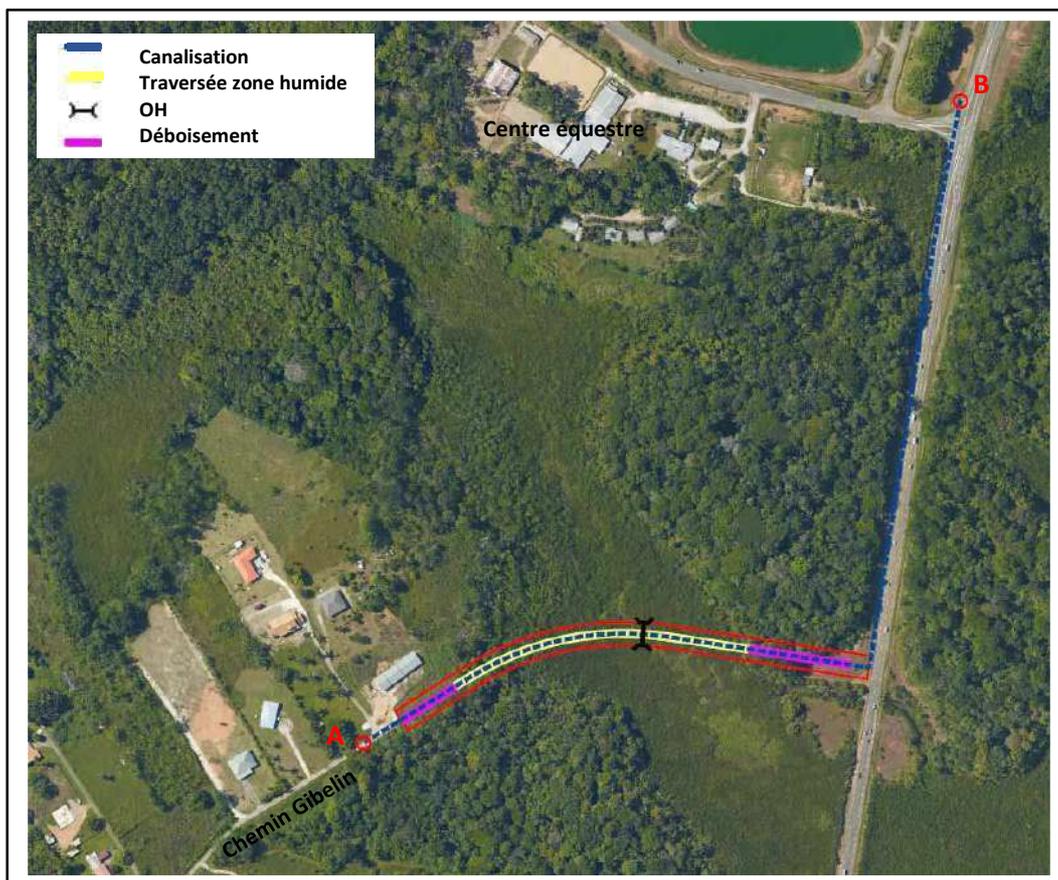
Variante n°2 sur le tracé de la conduite d'adduction
